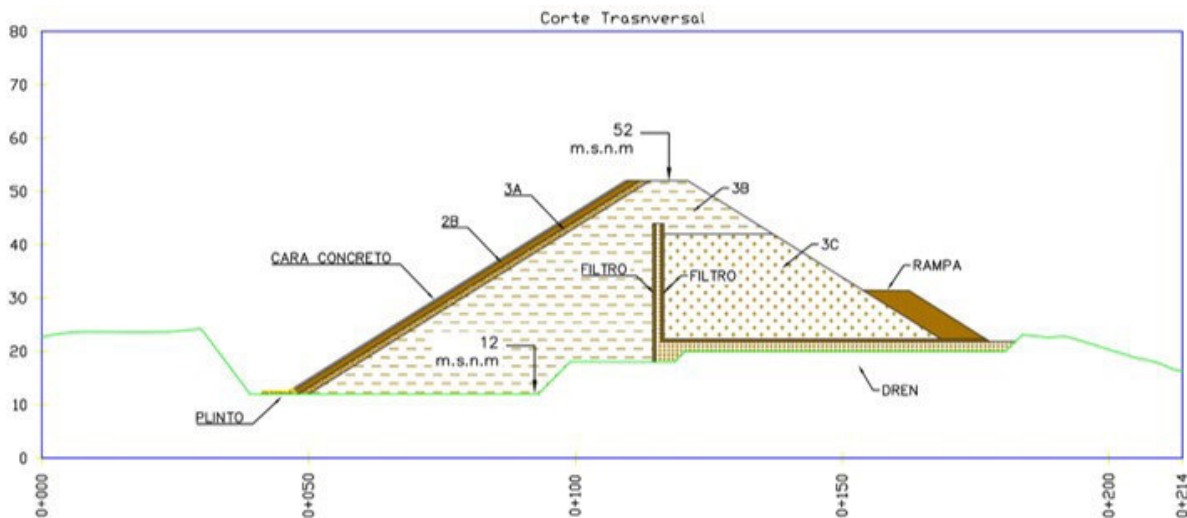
12 Propuesta Presa enrocado con Cara de Concreto PAACUME
